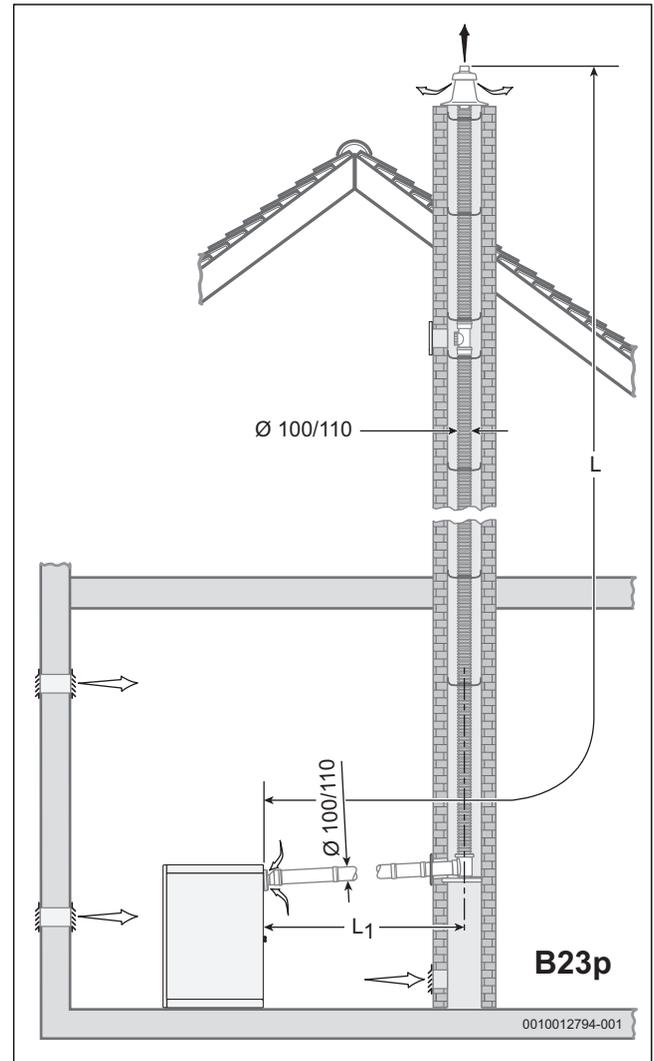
Exemple d'installation : conduit d'évacuation de fumées flexible B_{23p}
